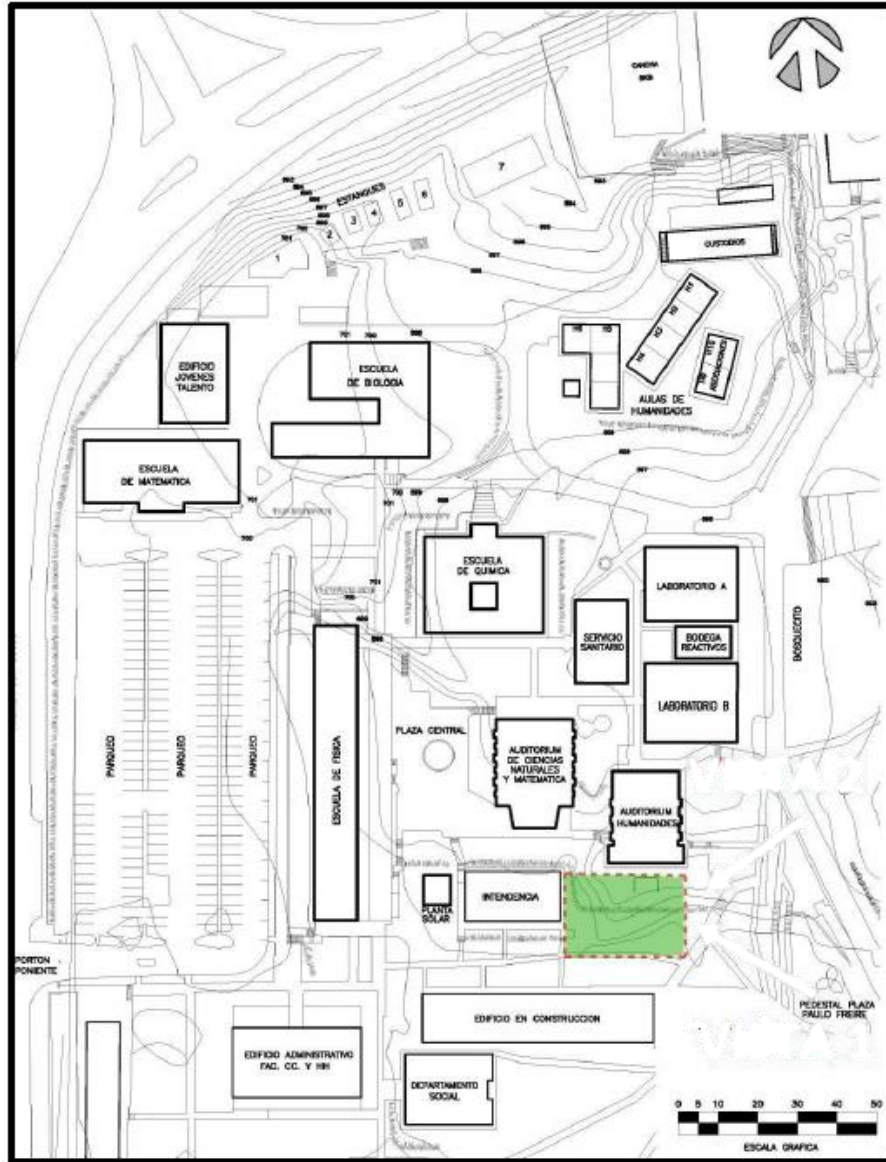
Plano de Ubicación de Terreno Alternativa 4.
